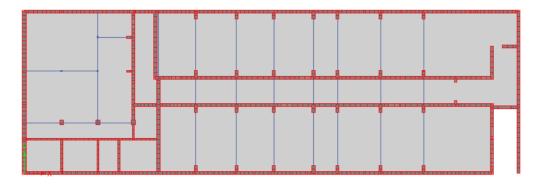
Planta segundo piso, Colegio Madres Domínicas Edificio 1.
